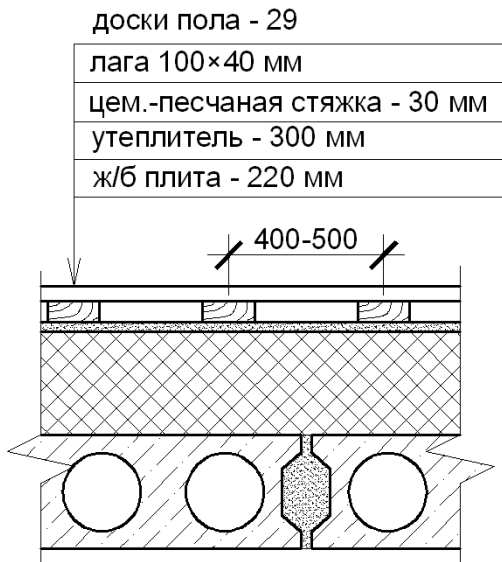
Перекрытие над неотапливаемым подвалом
